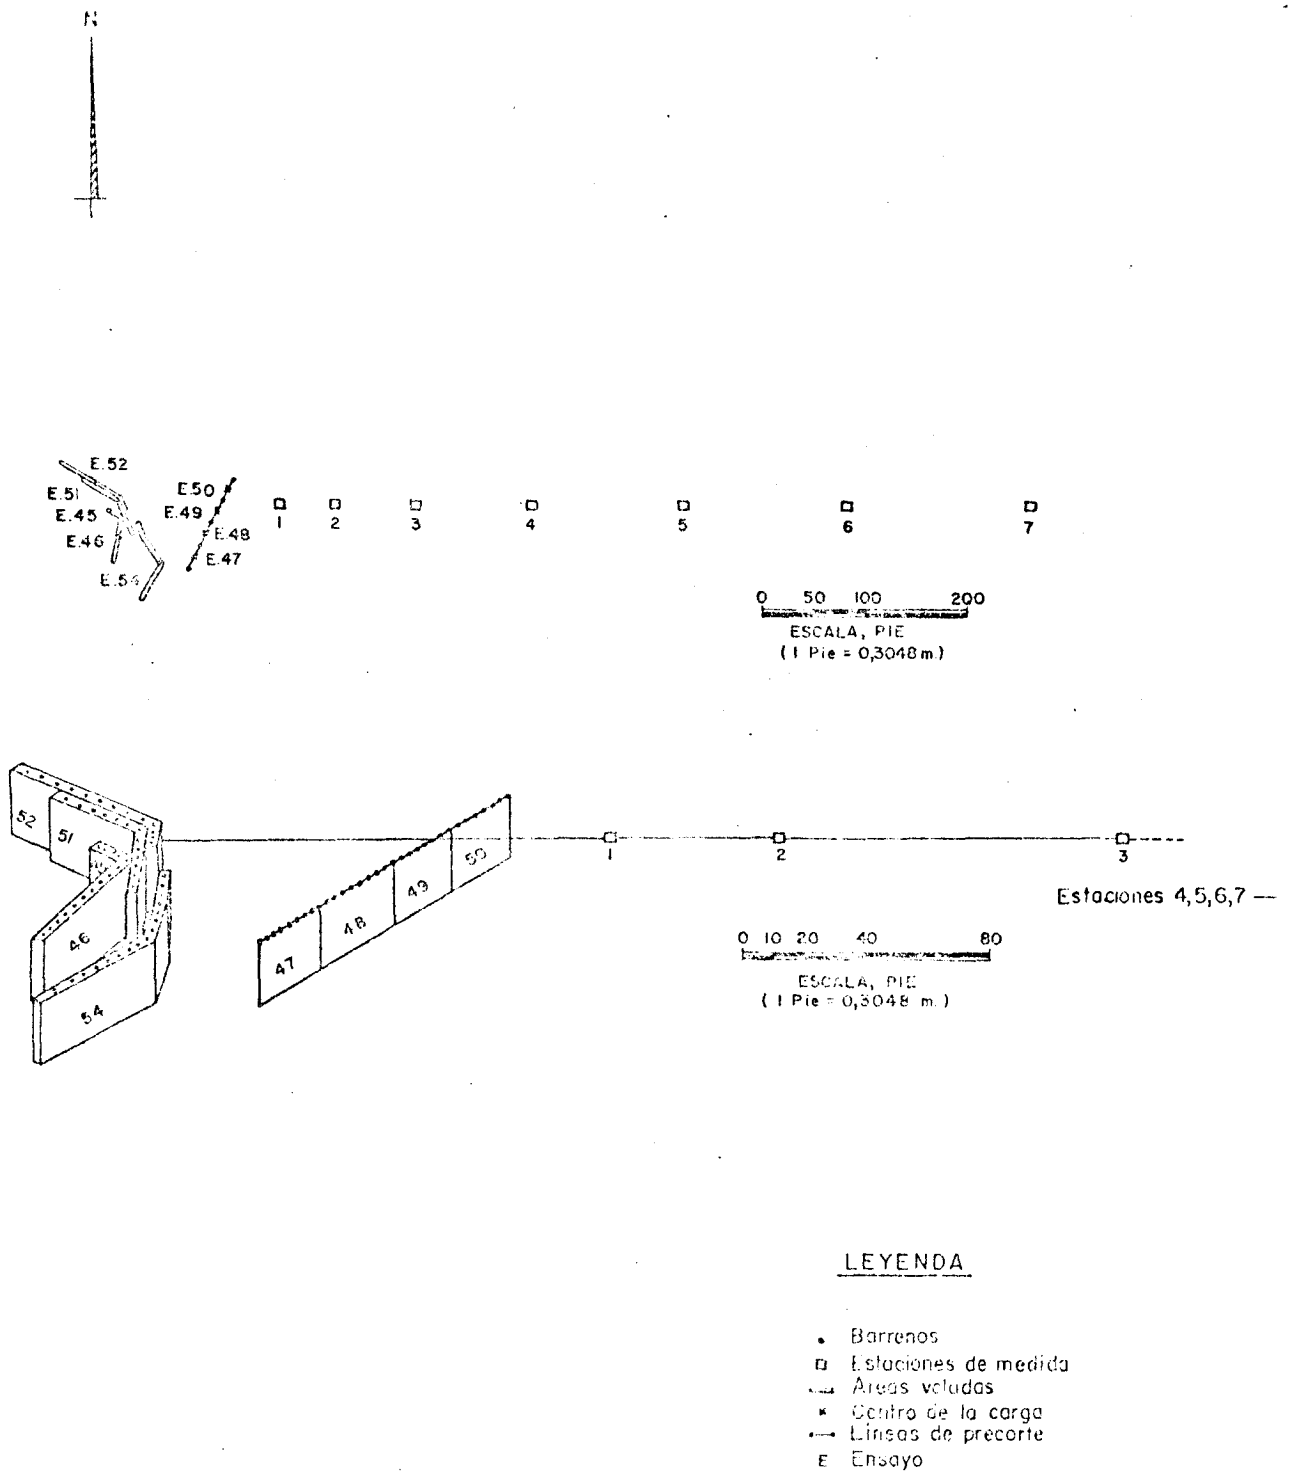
Plano y perspectiva del área de ensayo, Washington, D.C.
